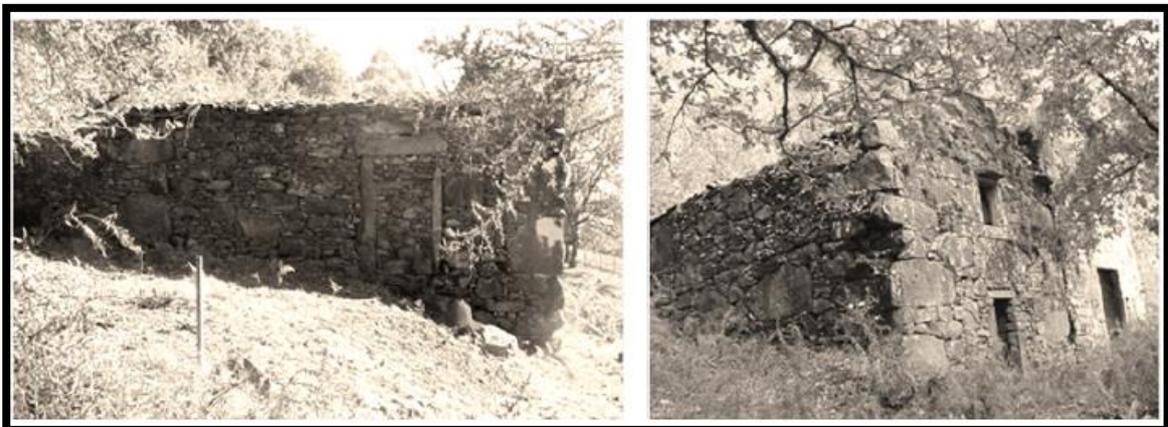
Vistas exteriores de las viviendas con tipología predominante de un nivel y 2 niveles.
